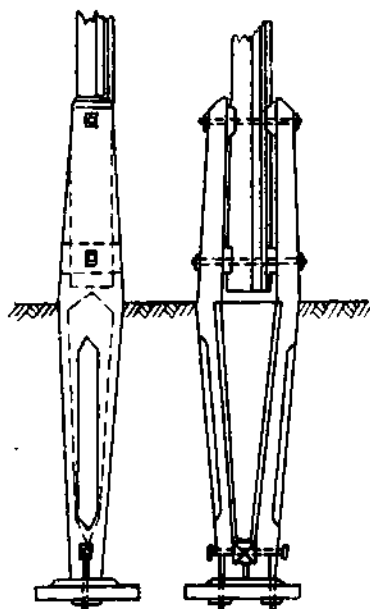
Clești de beton armat pentru fixarea stâlpilor de lemn în terenuri umede
